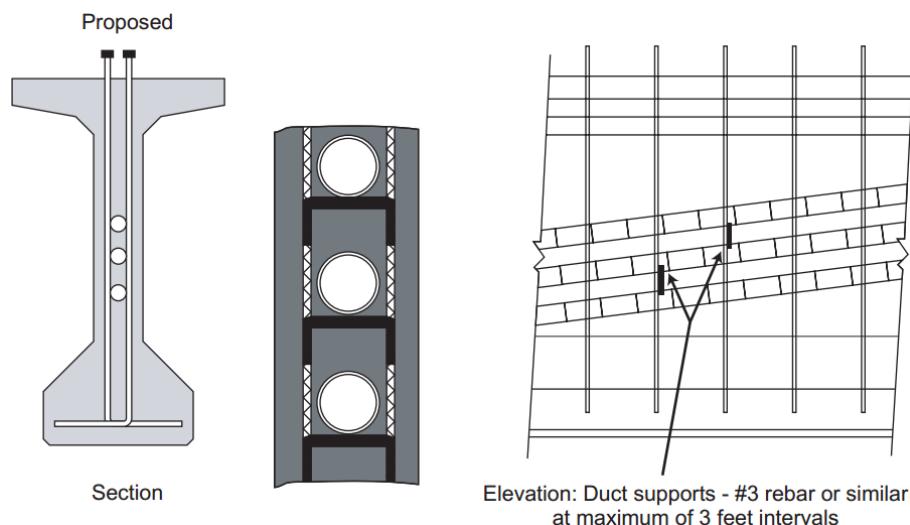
Soportes de ducto en vigas principales-I prefabricadas post-tensionadas.
